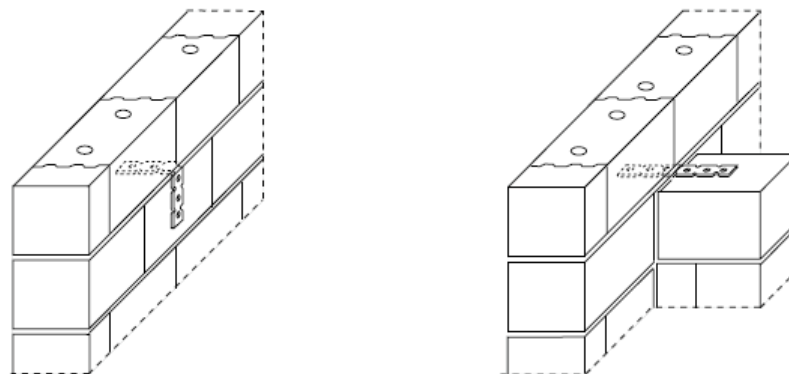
Anwendung von Edelstahl-Flachankern bei der KS-Stumpfstoßtechnik
